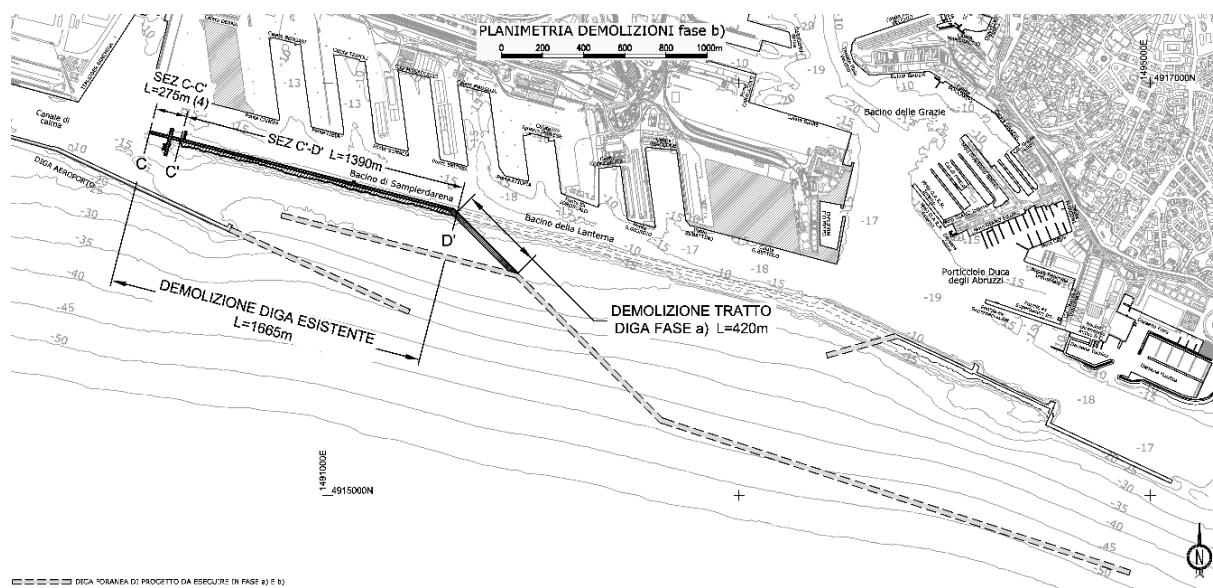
PLANIMETRIA DELLE DEMOLIZIONI PREVISTE IN FASE B)
